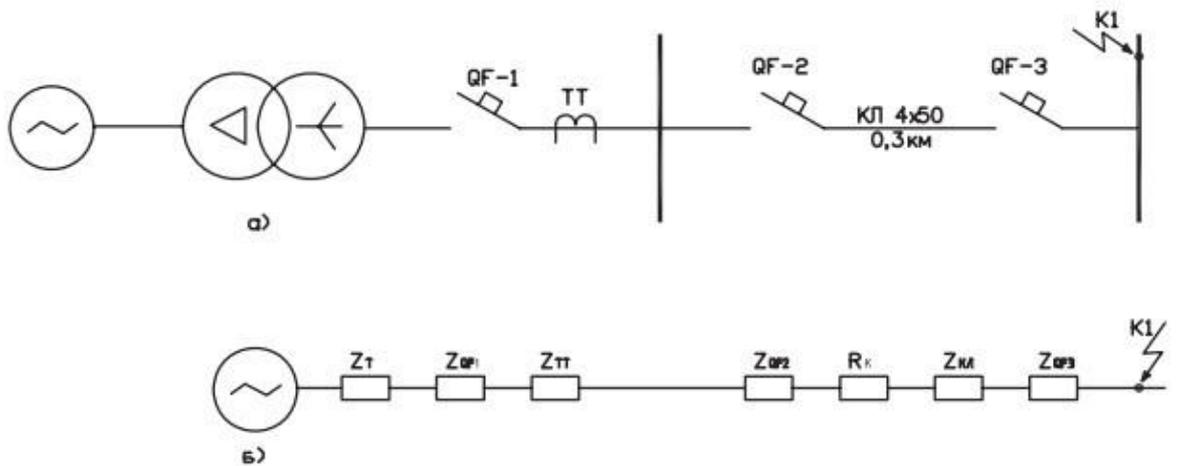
Расчетная схема (а) и схема замещения (б) электроснабжения жилого дома
